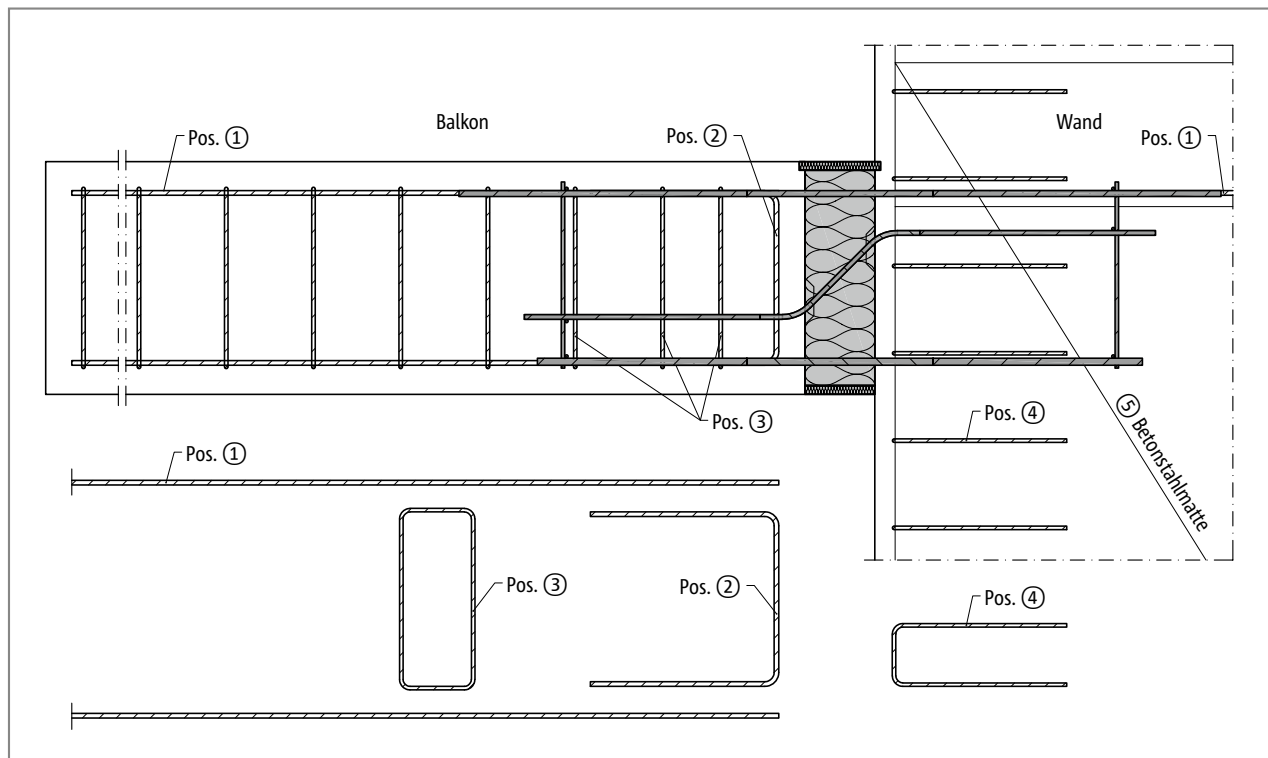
Schöck Isokorb® XT Typ BP: Bauseitige Armierung
